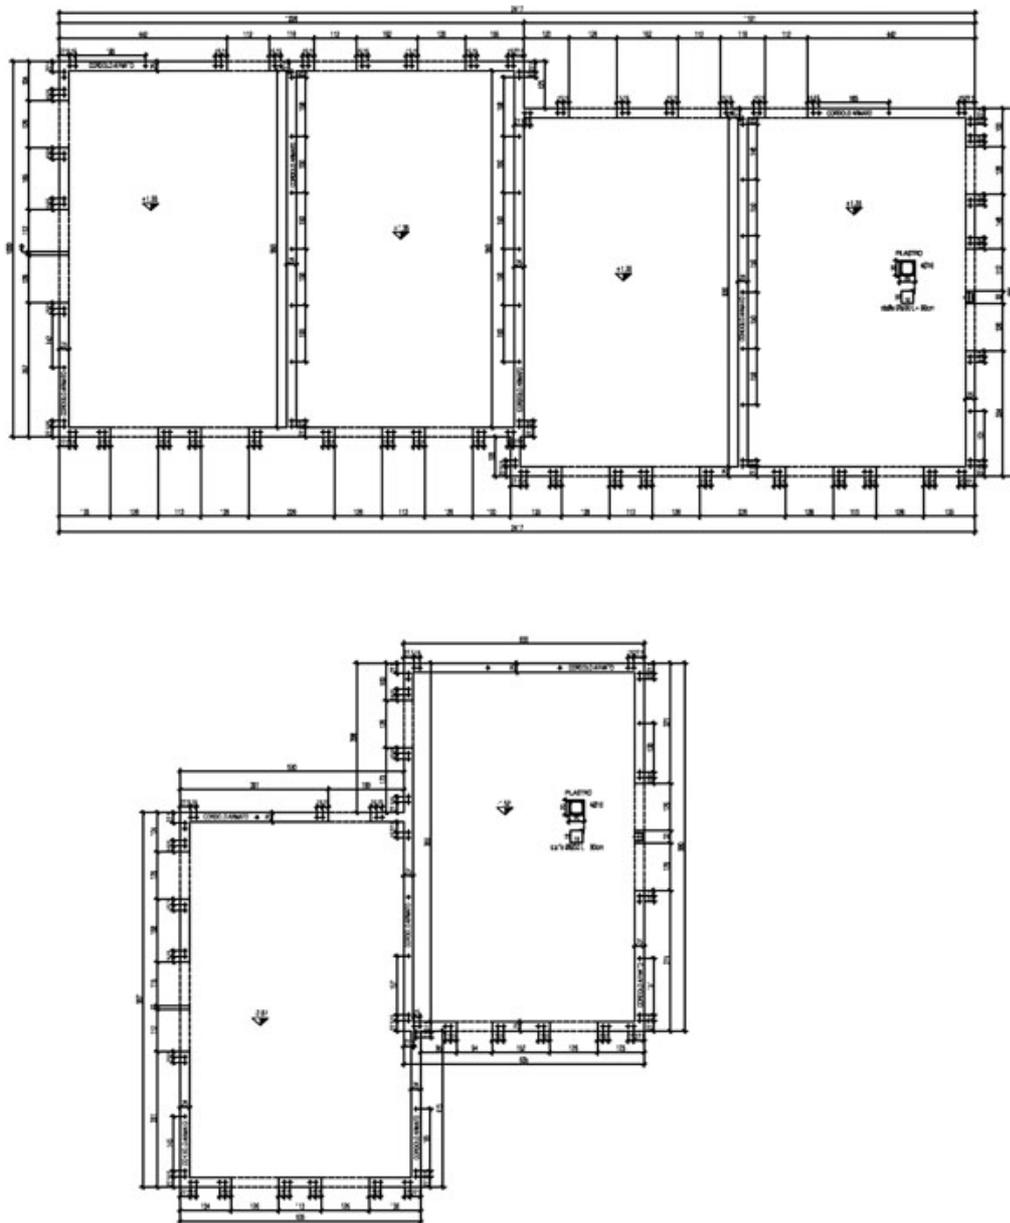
Pianta della struttura in muratura armata del piano tipo dei nuovi edifici a schiera.
